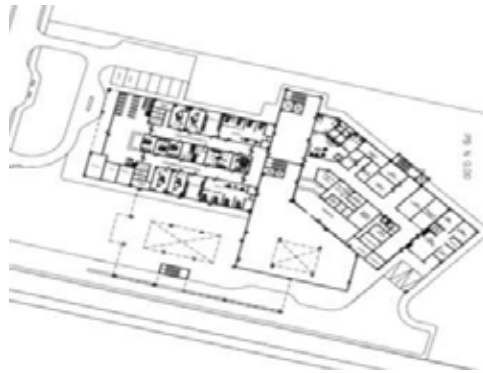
Planta baja conjunto del Hospital Tipo I. (2018)
